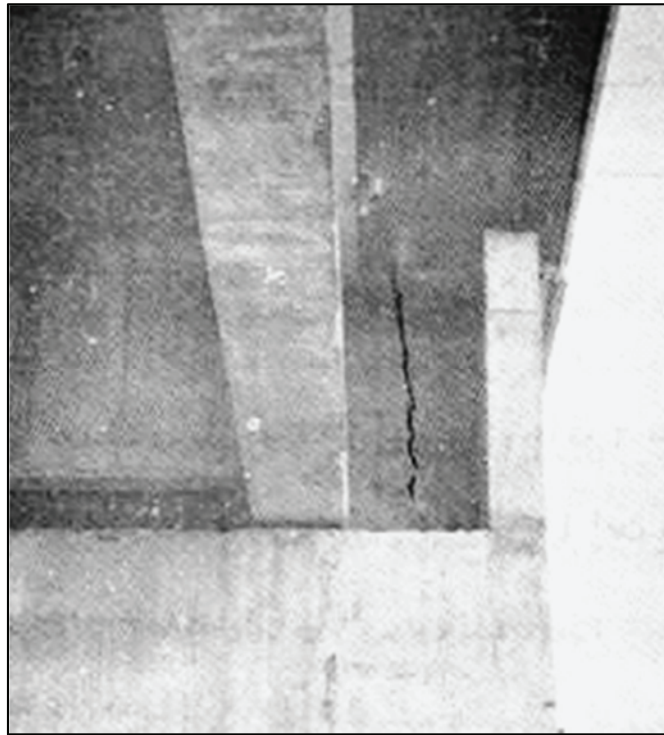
Agrietamiento del lado derecho de las tres vigas del puente. Una grieta similar se generó del lado izquierdo, no indicado en esta Figura. (Fuente: Moinfar, 1972, p. 7)
